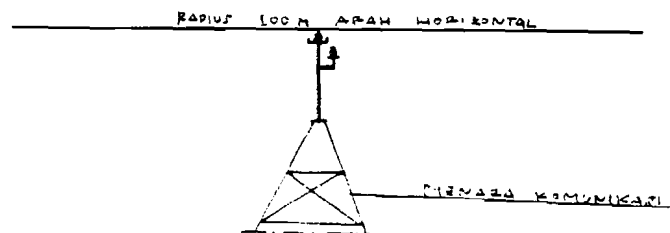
Mekanikal Elektrikal sketsa dan pada bangunan.
